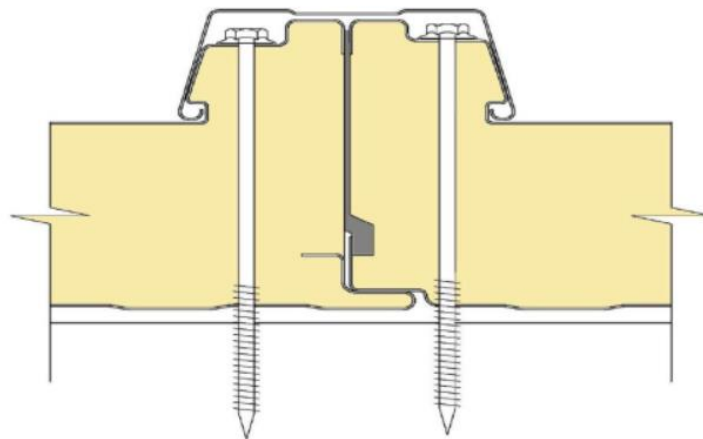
Detalle Unión y Tapajuntas. Fuente: (<https://www.dippanel.com/panel-construccion/panel-sandwich-de-cubierta/panel-con-tapajuntas-de-3-grecas/>)
